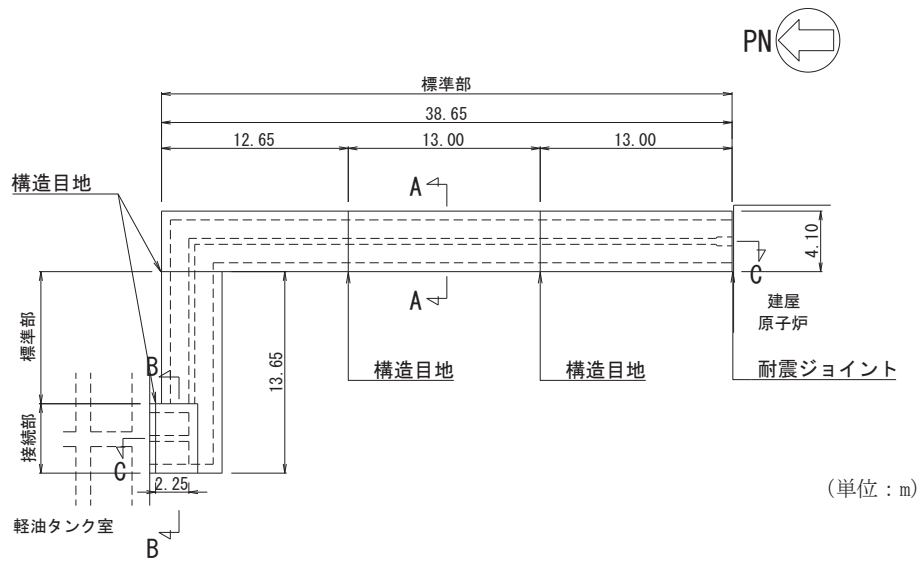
(2) 軽油タンク連絡ダクト平面図 (詳細)
